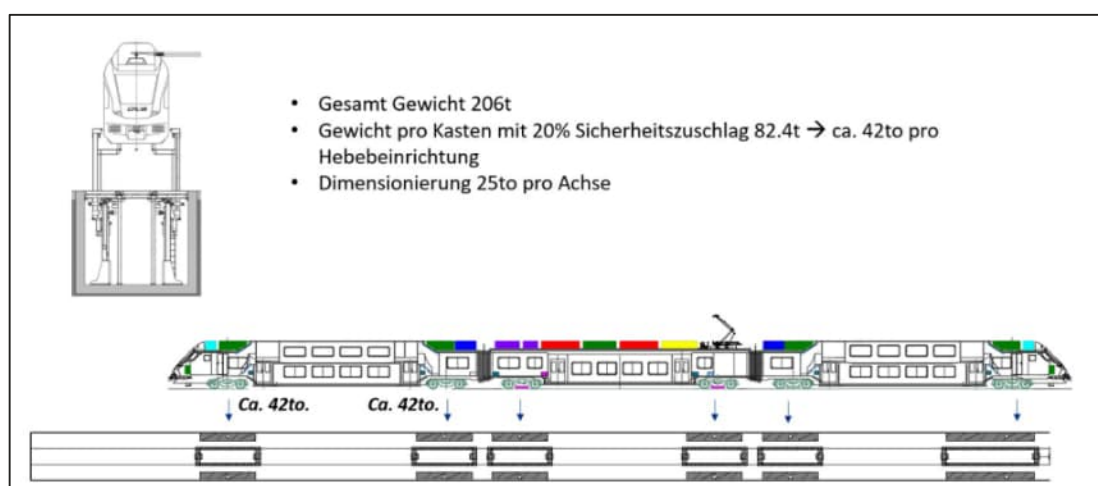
Vue en coupe et en plan des dispositifs de levage de trains
